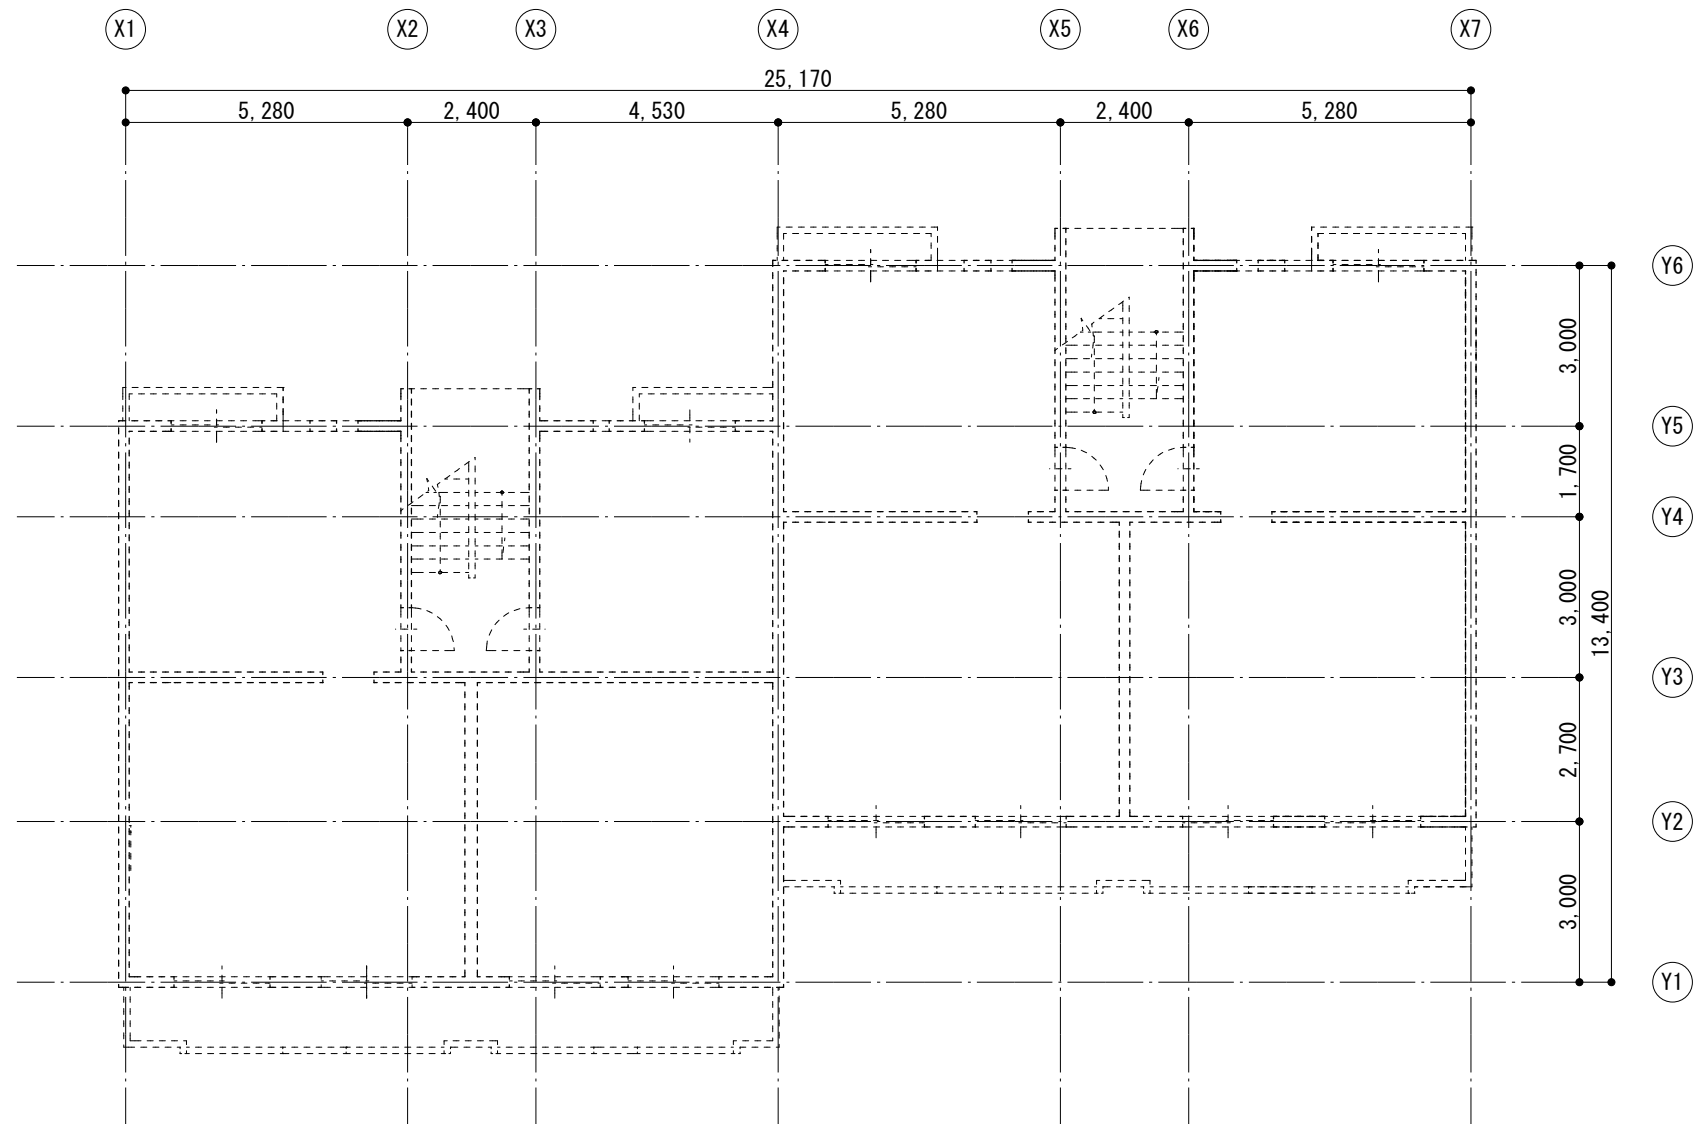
号棟 配置 平面図	縮尺	1/100	図面番号	M-01	校の内 号図
